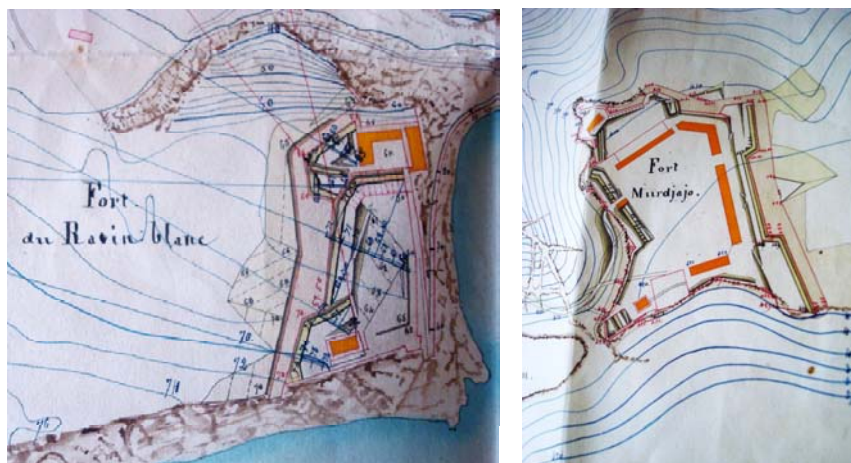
y 9: El proyecto de la fortificación de Murdjadjo (Archivo de Château de Vincennes).
